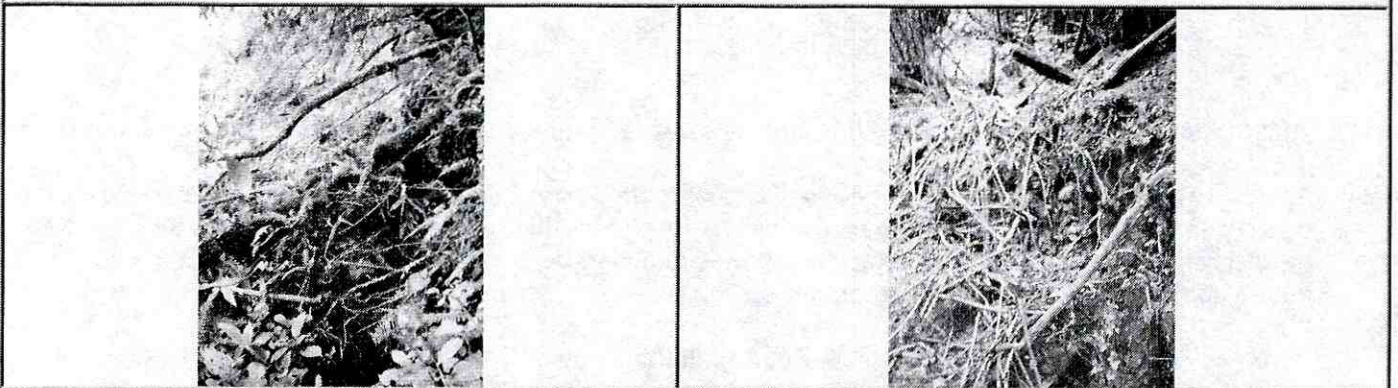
y 8. Se observa grietas de tracción en la parte baja del talud y por otra parte se observa el afloramiento de agua en la parte media de la ladera, la cual se infiltra en la masa de terreno movilizado.
